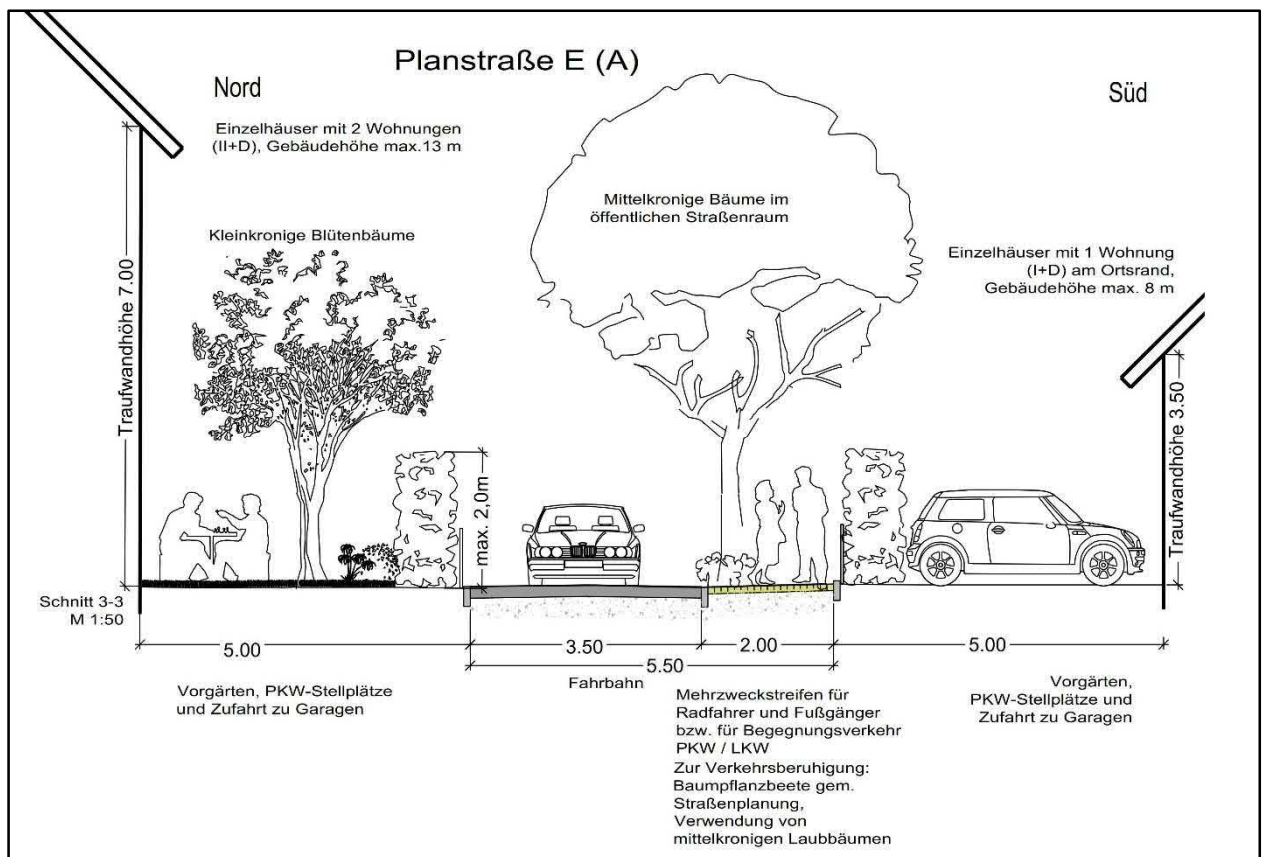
Straßenquerschnitt 5,5 m (Planstraßen E und A)
